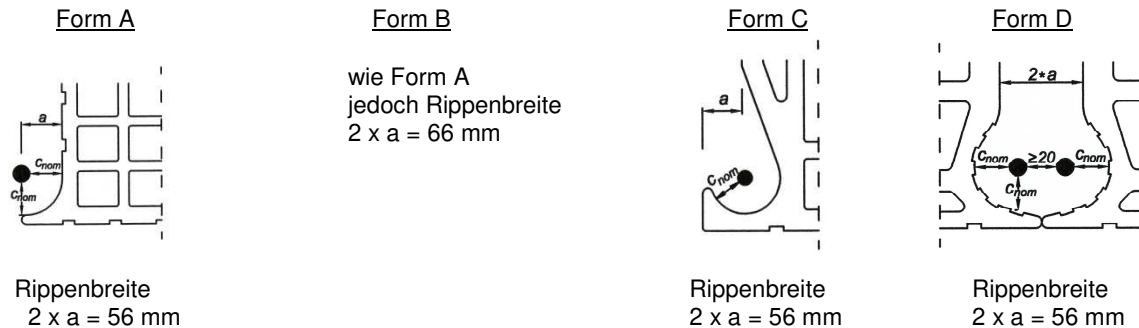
Fußleistenformen mit Bewehrung und erforderlicher Betondeckung nach Tabelle MB 3
